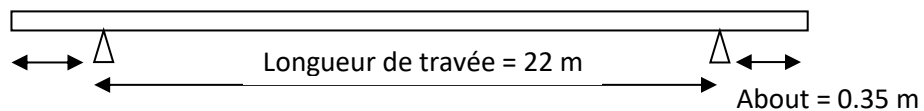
Coupe longitudinale d'une poutre du tablier de la variante 1
